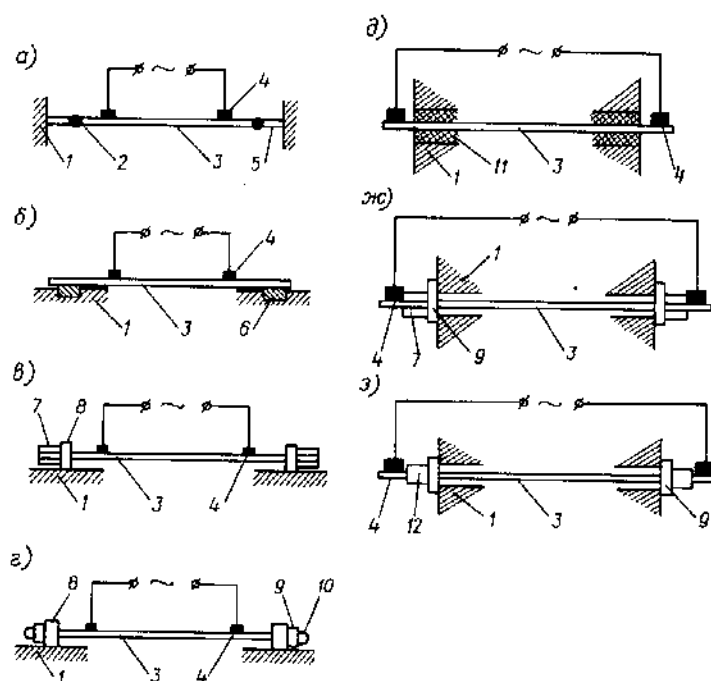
Технологічні схеми електротермічного напруження стрижневої арматури в умовах будівництва: 1 – залізобетонна конструкція; 2 – зварений стик арматури; 3 – напружувана арматура; 4 – контактні затискачі; 5 – випуски робочої арматури; 6 – закладна деталь; 7 – упорні коротуни; 8 – анкерний упор; 9 – упорна шайба; 10 – давлена головка; 11 – швидкоотжавіюча смола; 12 – анкерна муфта
